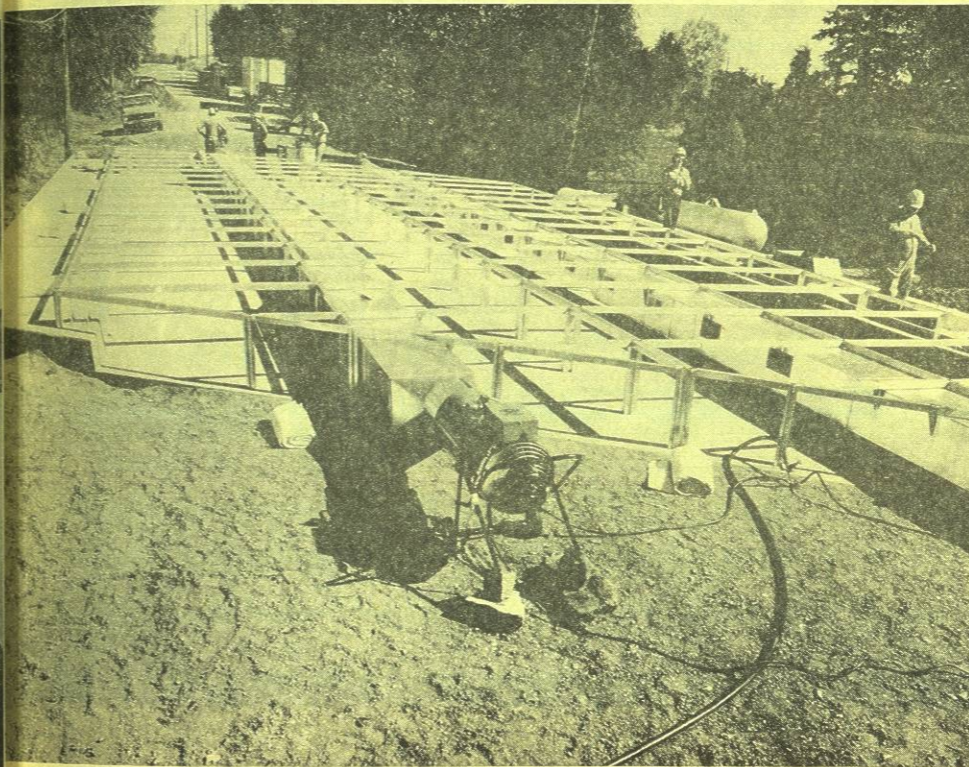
Armazón del encerramiento para aplicar calefacción durante la impregnación superficial de una losa de puente. Se colocan paneles aislantes sobre la armazón durante la aplicación de calor. El encerramiento se retira para aplicar el monómero.
